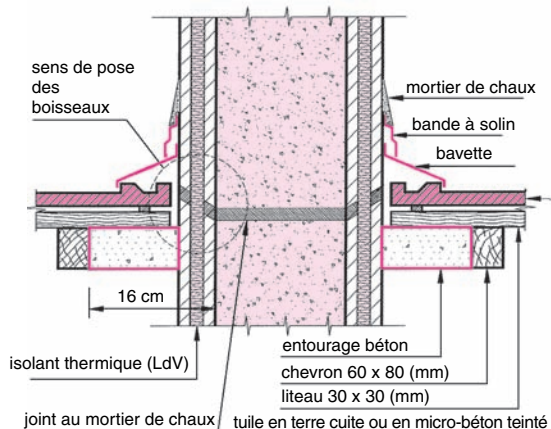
Détail d'étanchéité autour du conduit en coupe horizontale du toit
